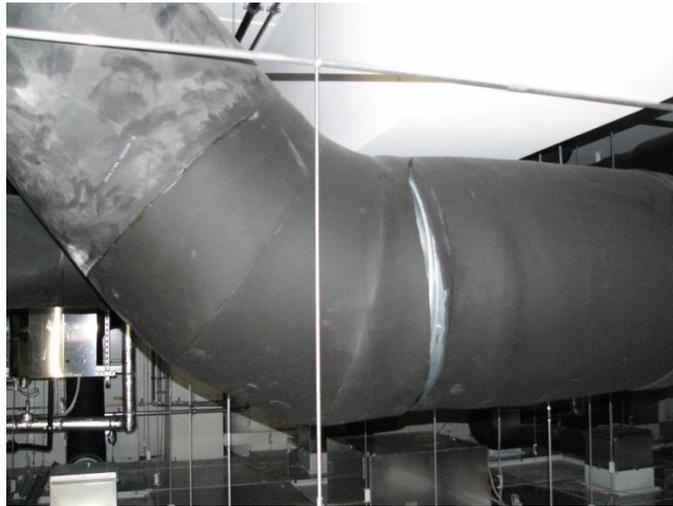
Geplatzte Isolierung, bedingt durch die unsachgemäße Wiederverwendung bereits montierter Bauteile
